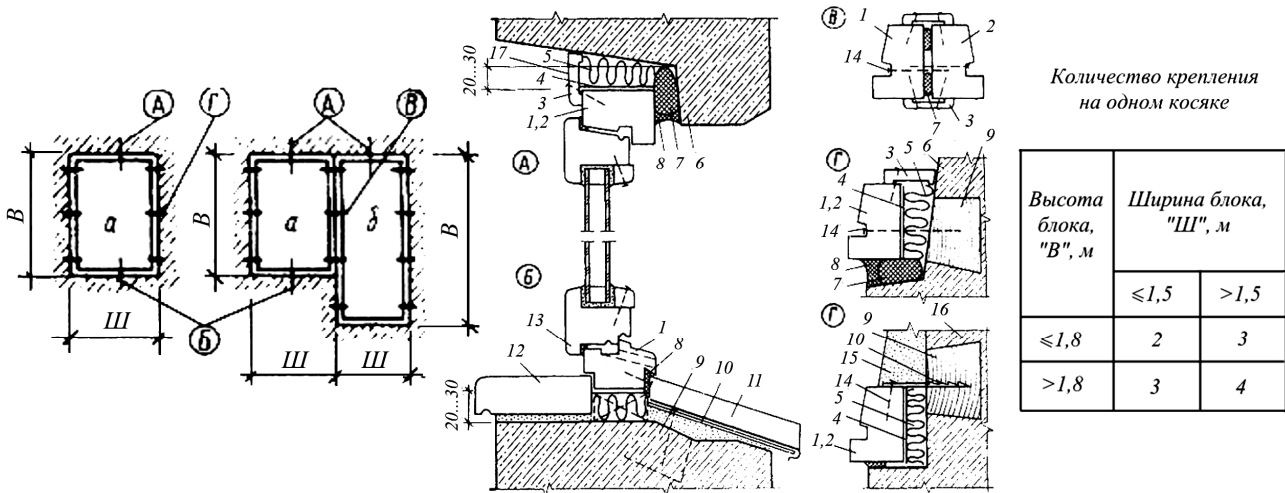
Крепление деревянных оконных блоков и блоков балконных дверей к стенам и герметизация стыков:
